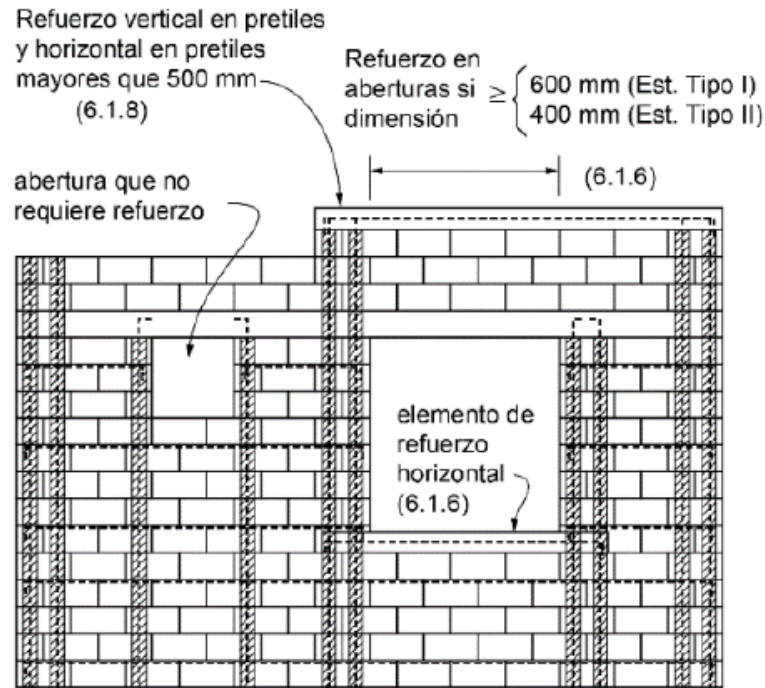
Requisitos para mampostería con refuerzo interior
